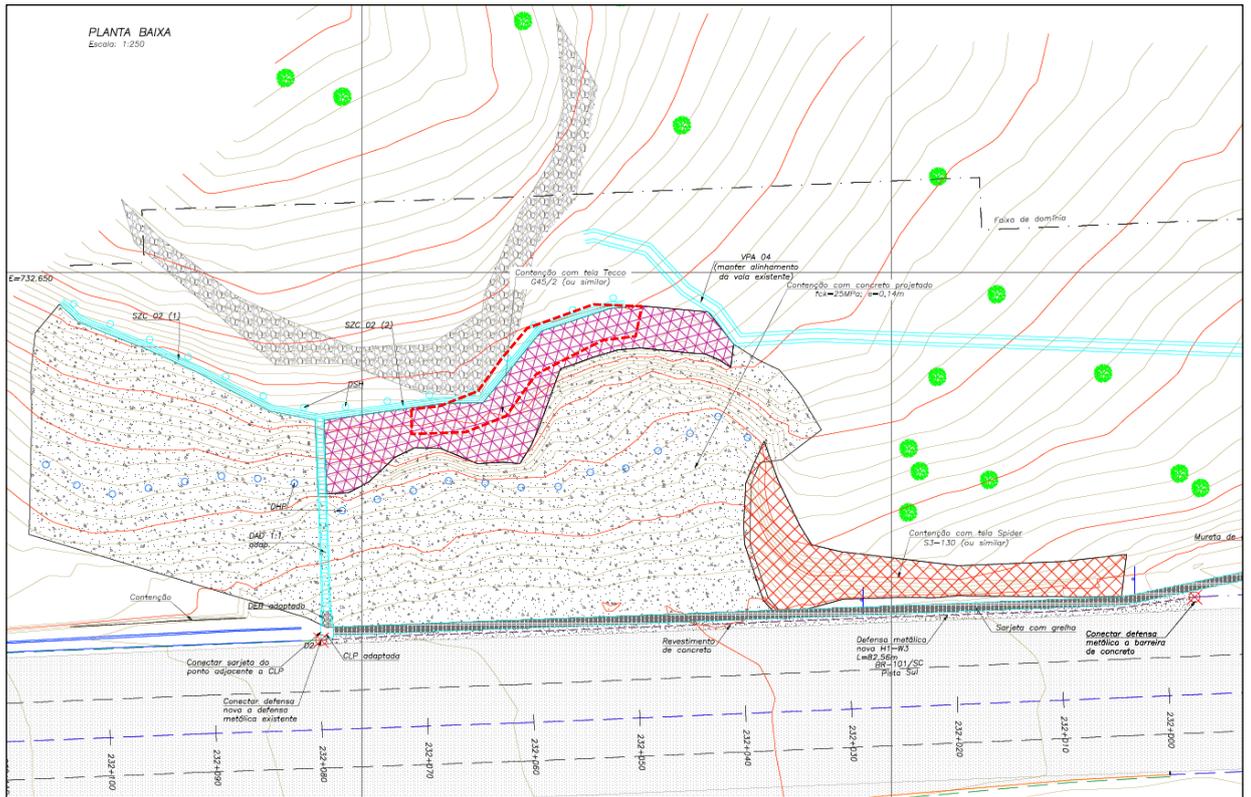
Planta indicando o segmento de canaleta que poderá ser suprimido provisoriamente e reavaliado.
